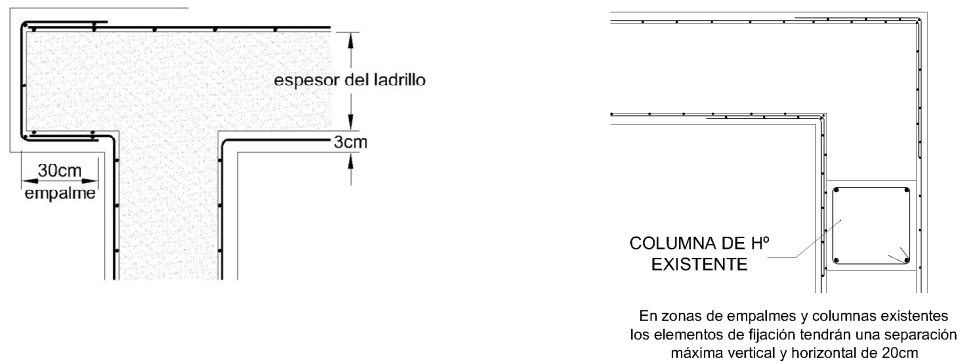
Detalles 3 y 5: Anclaje de armaduras en correspondencia con aberturas, en zona de columnas existentes y empalmes en encuentro de muros
